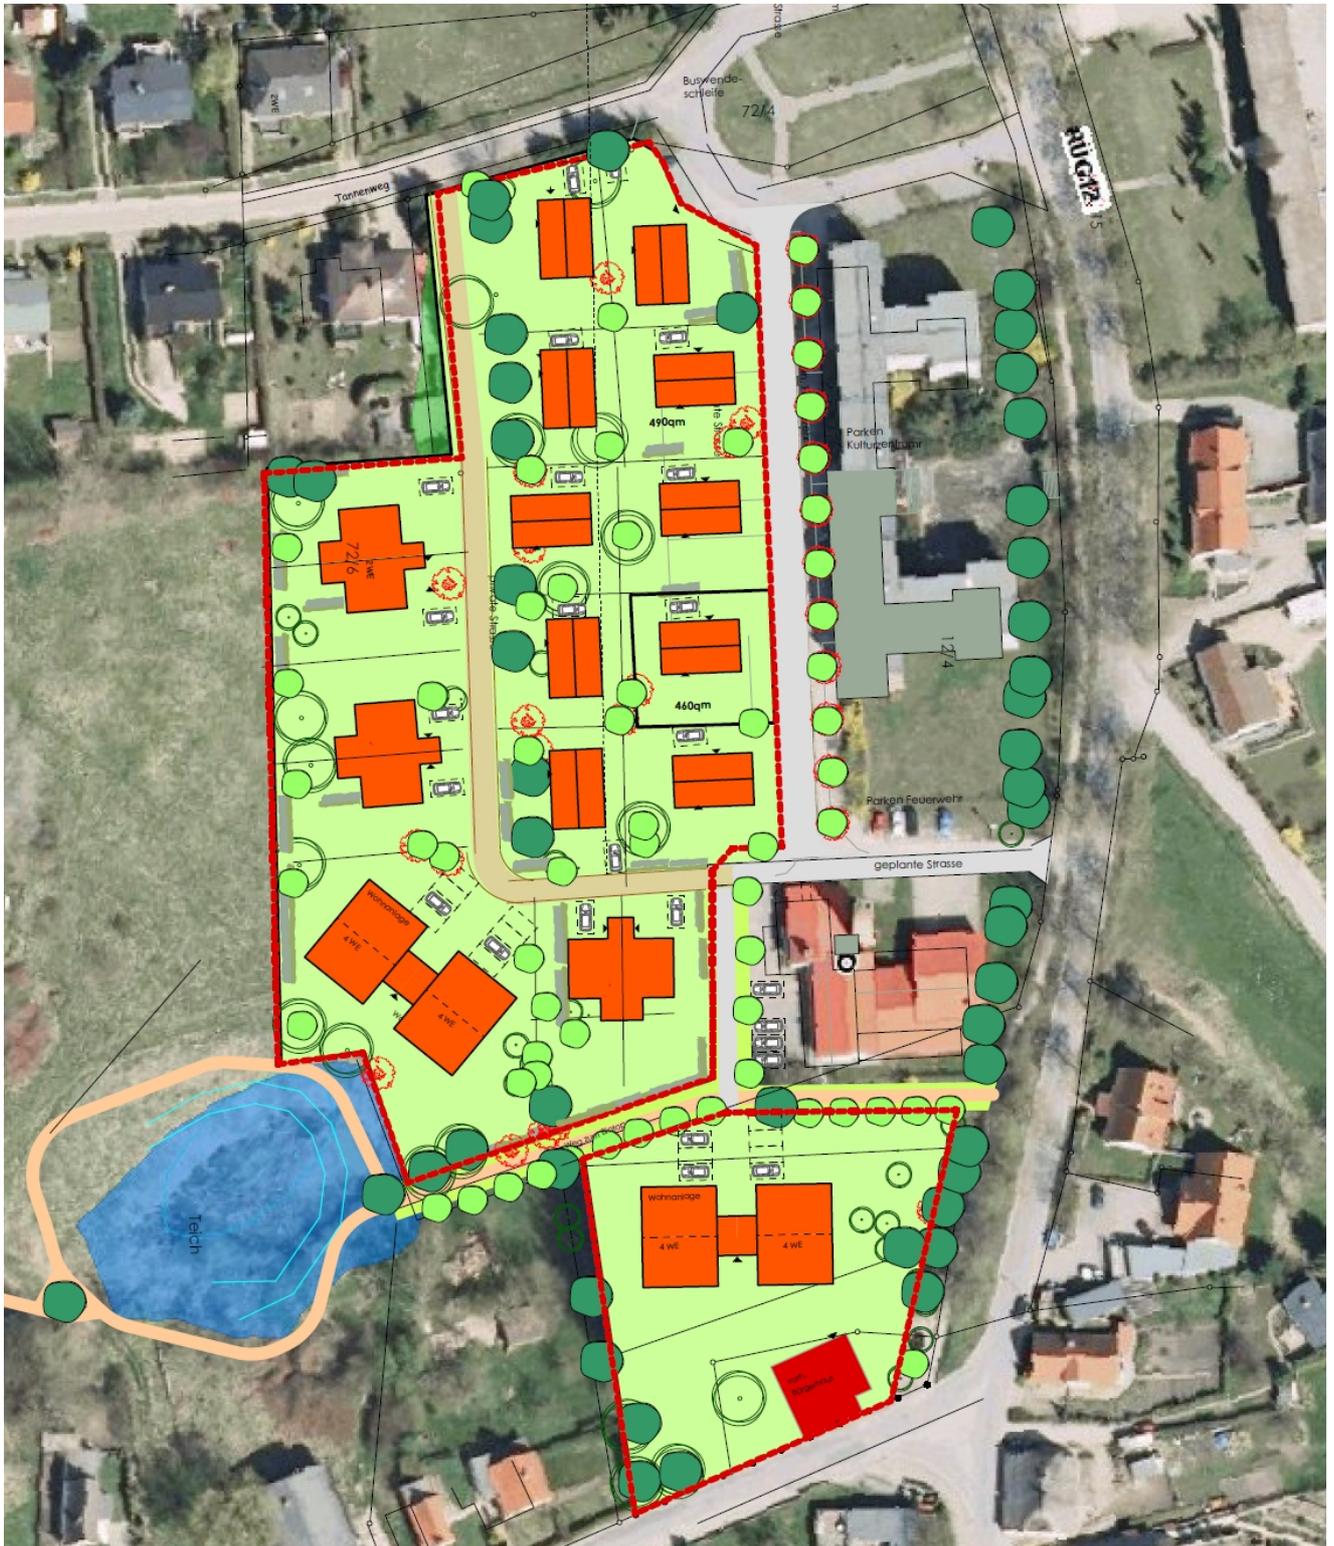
Städtebaulicher Lageplan (Stand 11/2010)
